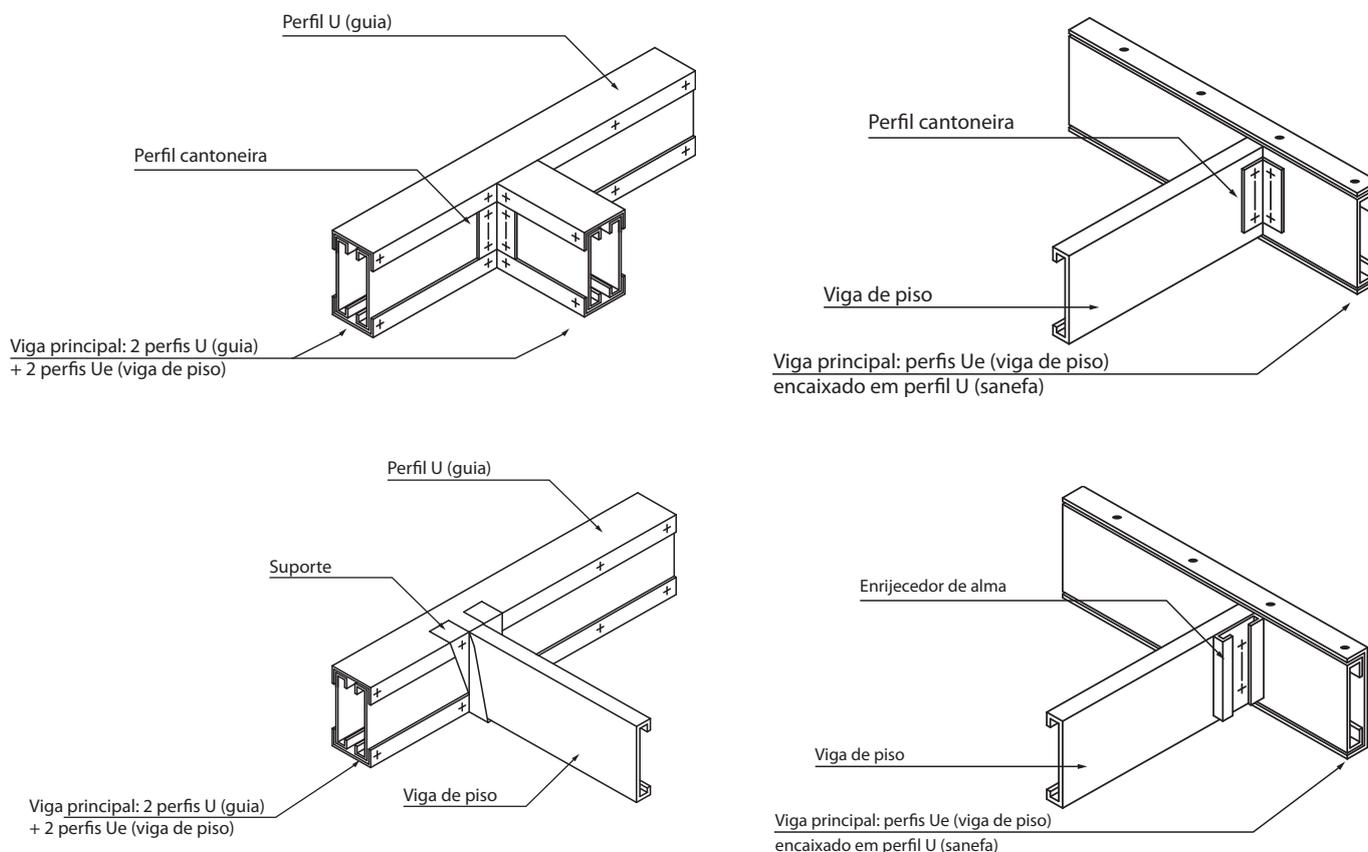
Tipos de vigas principais para apoio de vigas de piso
